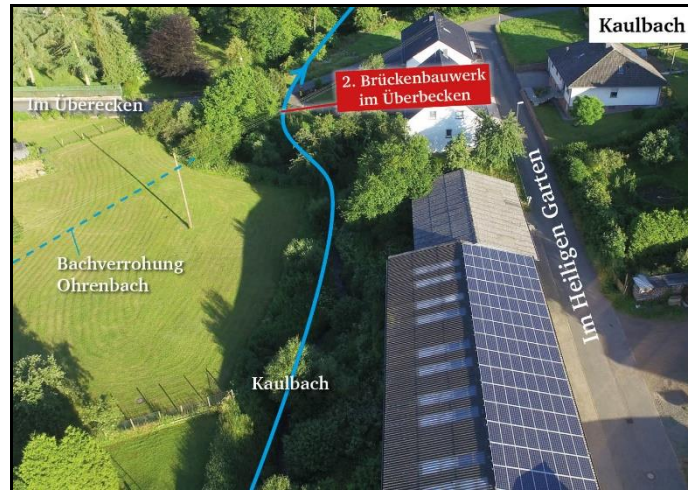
Gewässerverlauf vor 2. Brückenbauwerk „Im Überecken“, samt Lage Bachverrohrung Ohrenbach
